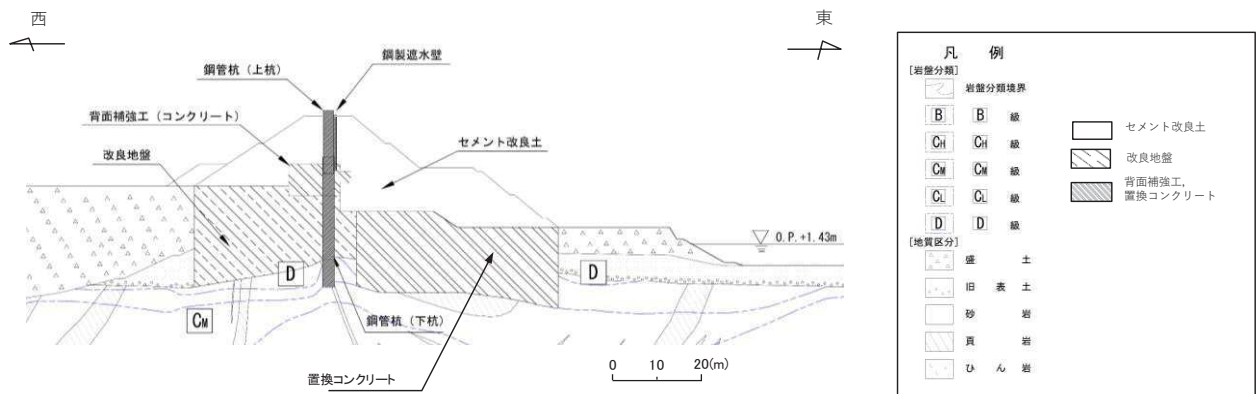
(1) 鋼管式鉛直壁 (一般部) 断面図 (I 区間)
